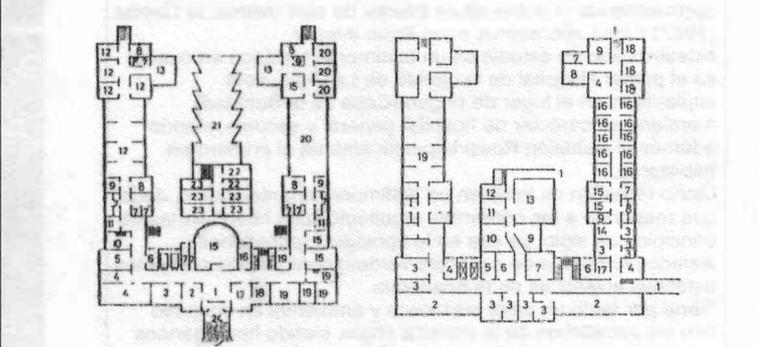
PLANTA BAJA Y SUBSUELO ACTUAL
